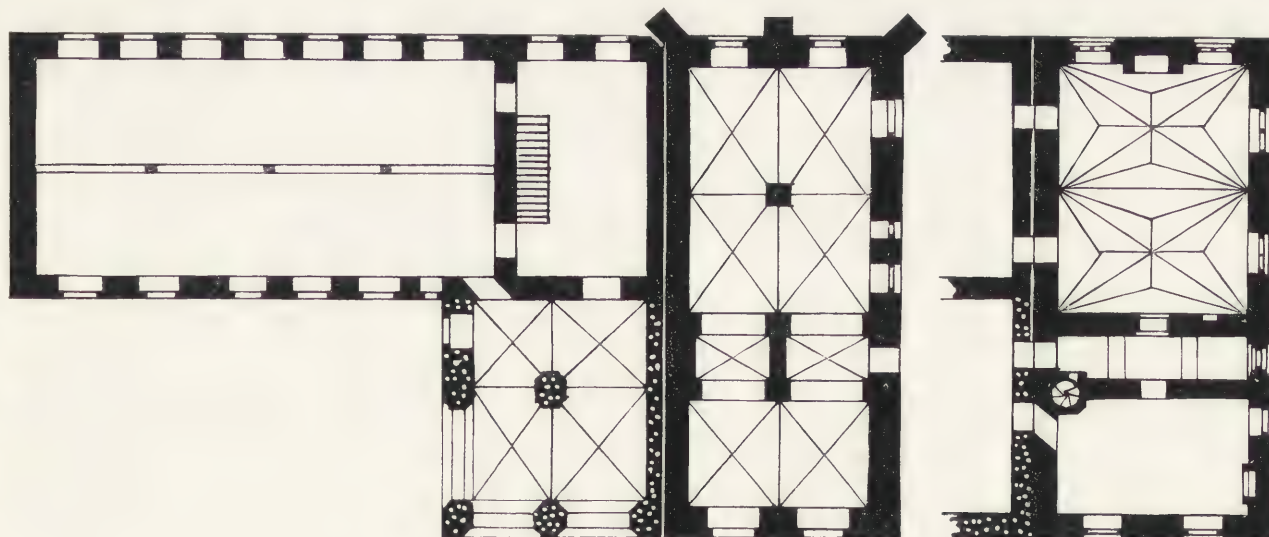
Rathaus zu Salzweel. Grundrisse vom Erdgeschoß und ersten Stock.
